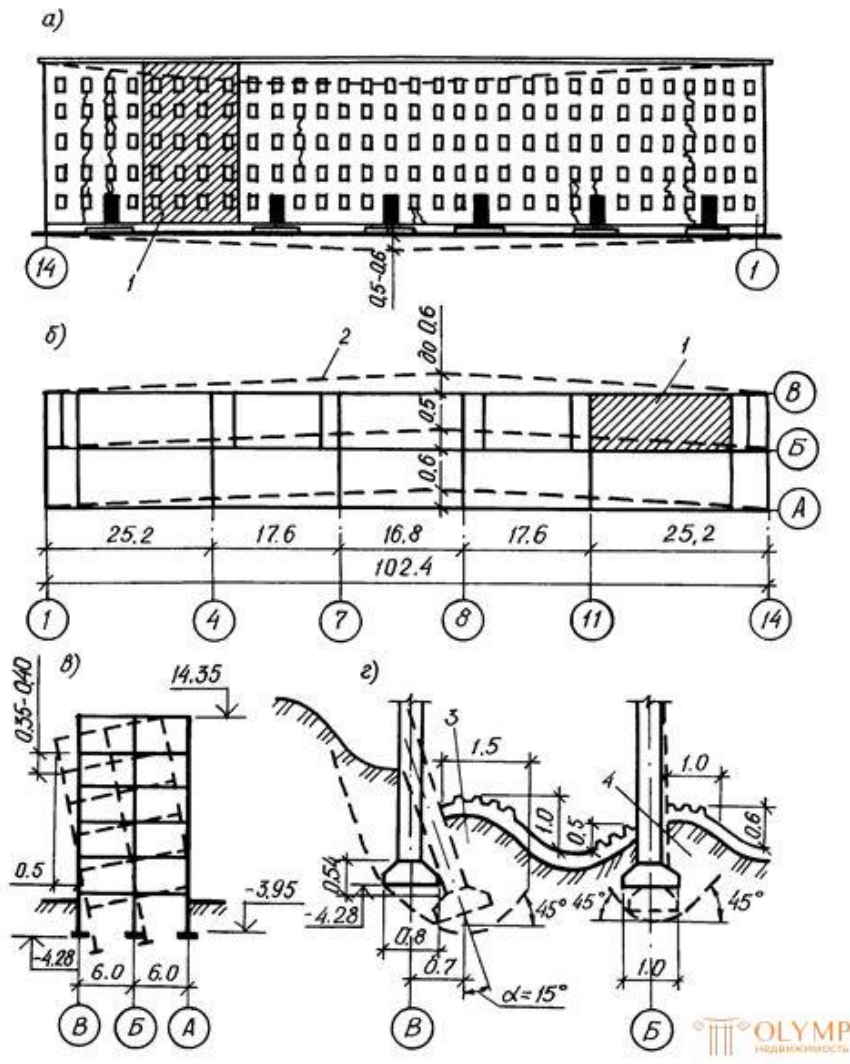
Аварийные деформации жилого дома в г. Туле. а - развитие деформаций в фасадной стене; б - смещение несущих стен в плане; в - поперечный разрез здания; г - смещение фундаментов. 1 - обрушившаяся часть; 2 - отклонение стены; 3 - выпор грунта; 4 - деформация пола подвала.
